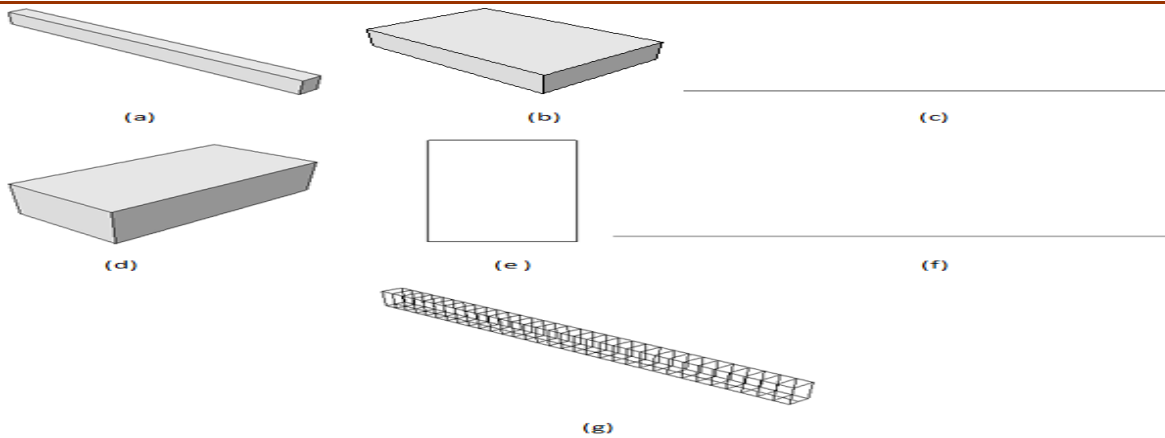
Les différentes parties de notre modèle; a)BEAM, b)BEARING, c)Compression Rebar, d)LOAD, e)Stirrup, f)Tension Rebar, g)REINFORCEMENT
